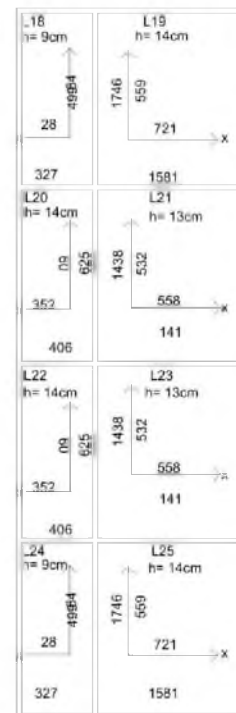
Momentos fletores característico (Mk - kN.cm/m) das lajes do segundo pavimento
